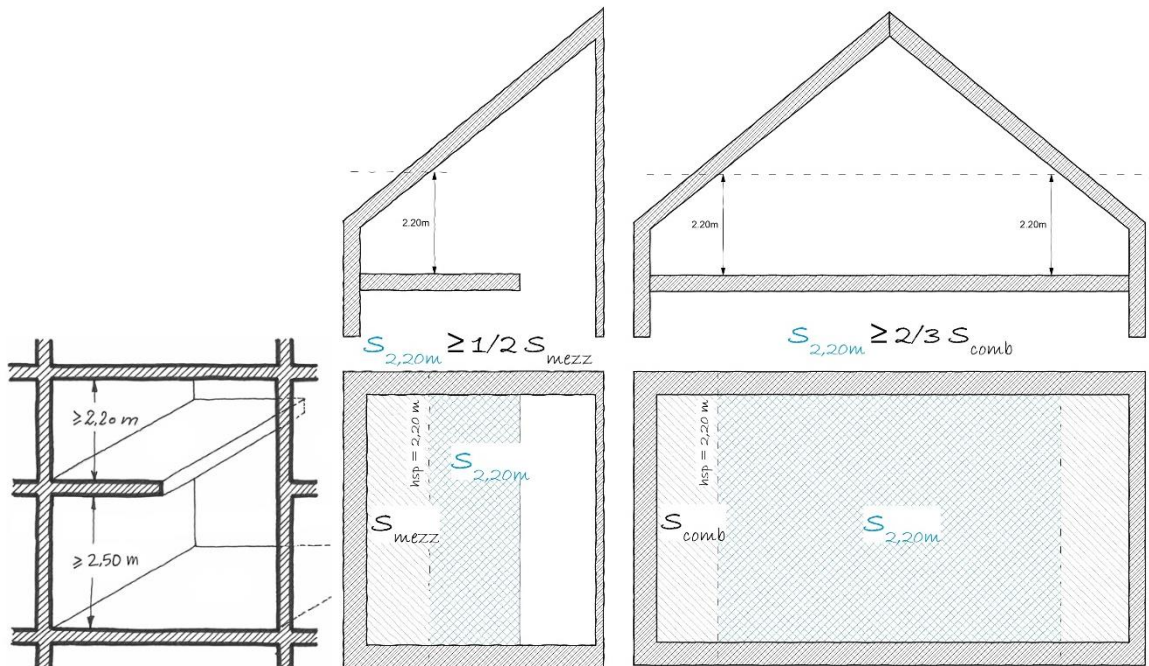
Hauteurs minimales sous plafond pour les mezzanines et les combles
